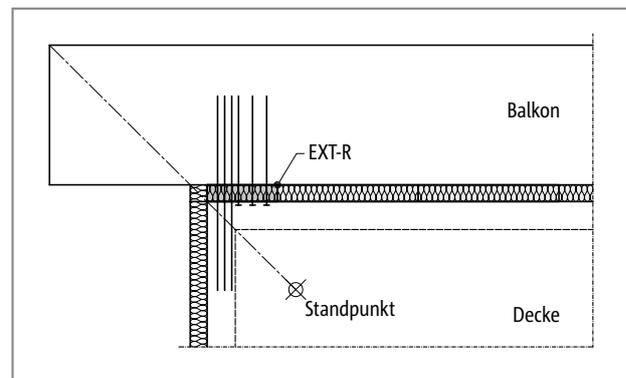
Schöck Isokorb® Typ EXT: Balkon über Gebäudeecke auskragend (Einsatz Typ EXT-R)
